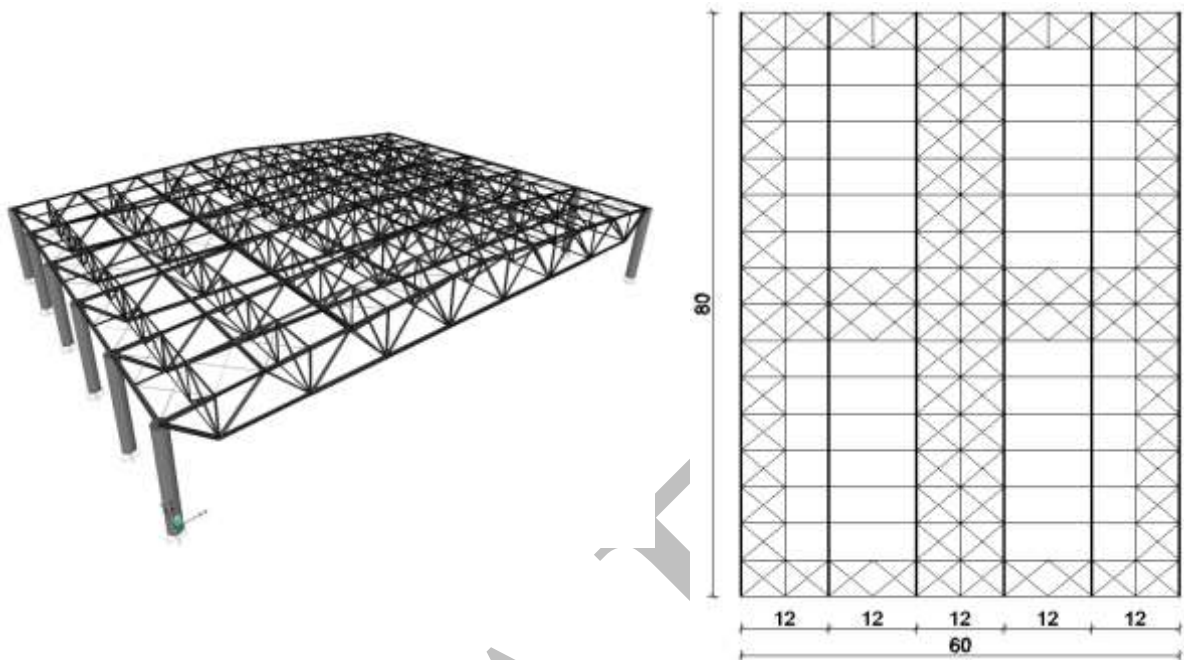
Structura cu deschidere de 80m (Str80m)
